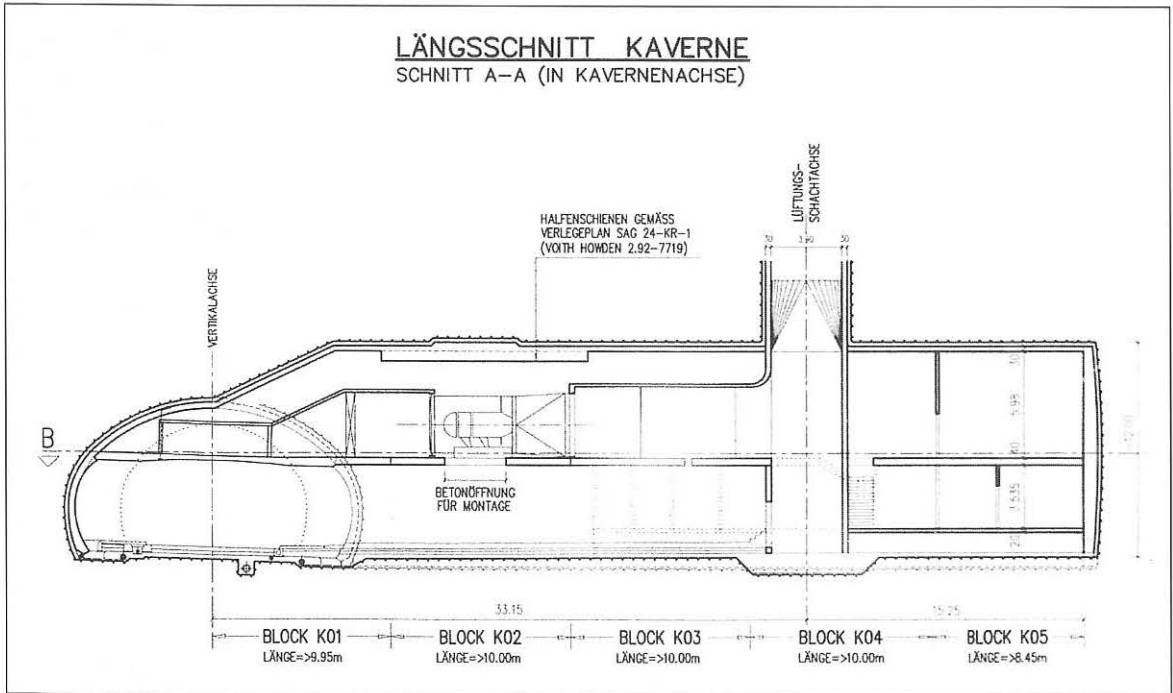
Längsschnitt der Lüfterkaverne des Umfahrungstunnels Stadt Bad Wildbad
